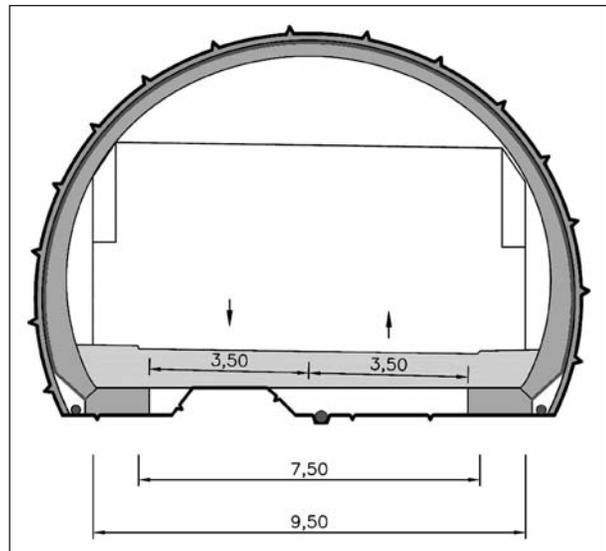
Beispiel eines typischen Regelquerschnittes eines Tunneln in geschlossener Bauweise mit Regenschirmabdichtung
